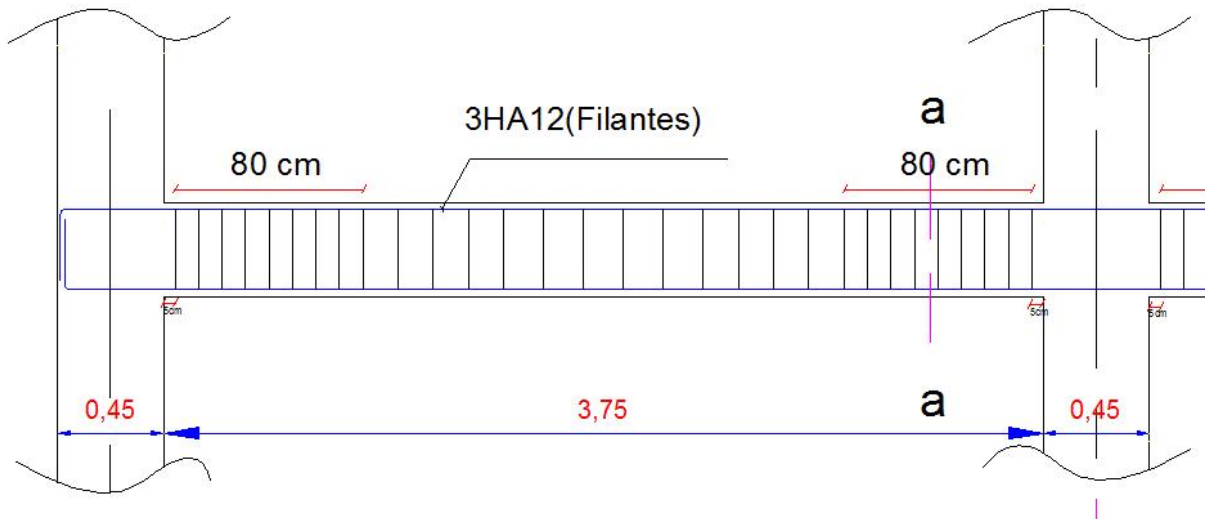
Le ferrailage de la poutre de chaînage.
